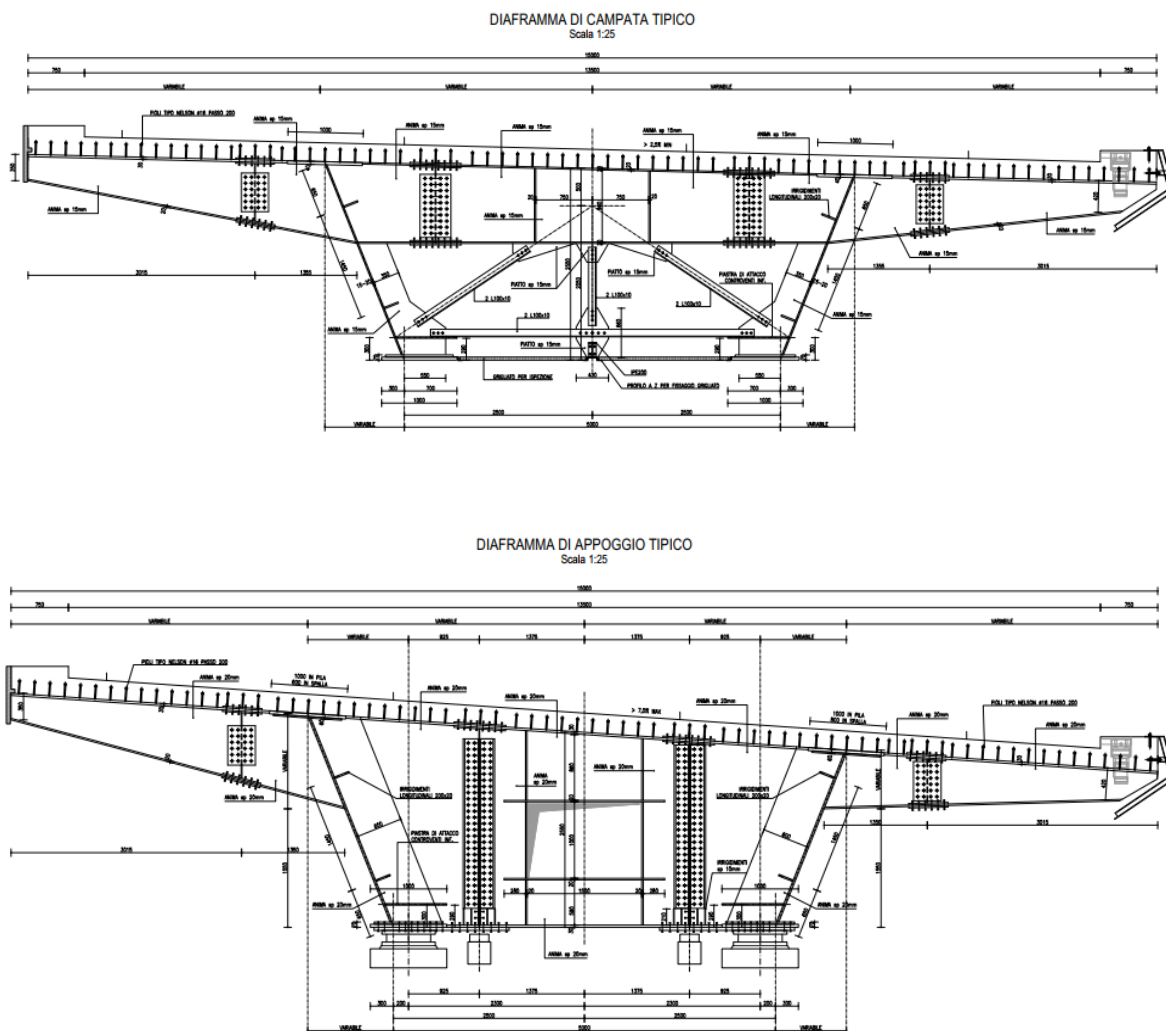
viste e sezioni principali – sezioni tipologiche impalcato
